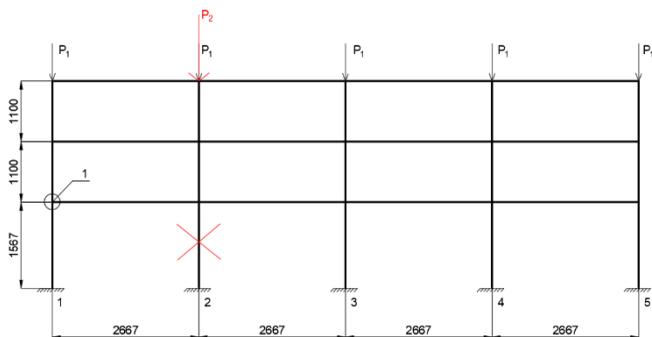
Расчетная схема железобетонной рамы; 1- рассмотренный узел
